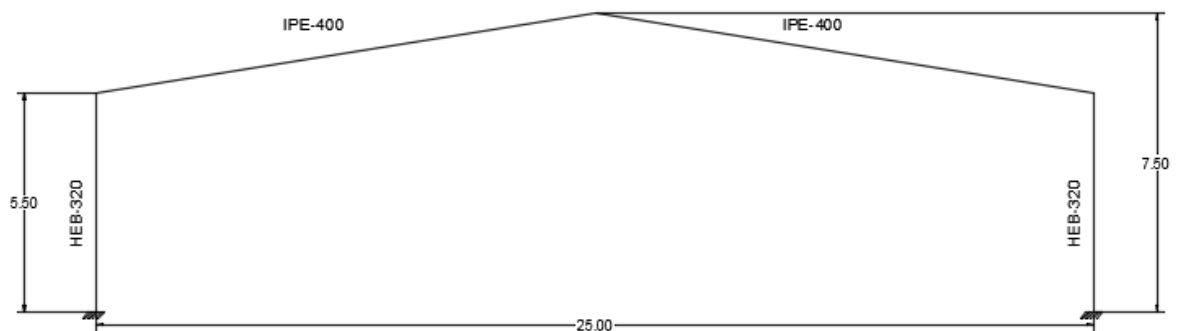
Dimensiones pórtico tipo central y perfiles de pilares y vigas. (CYPE, 2014).
